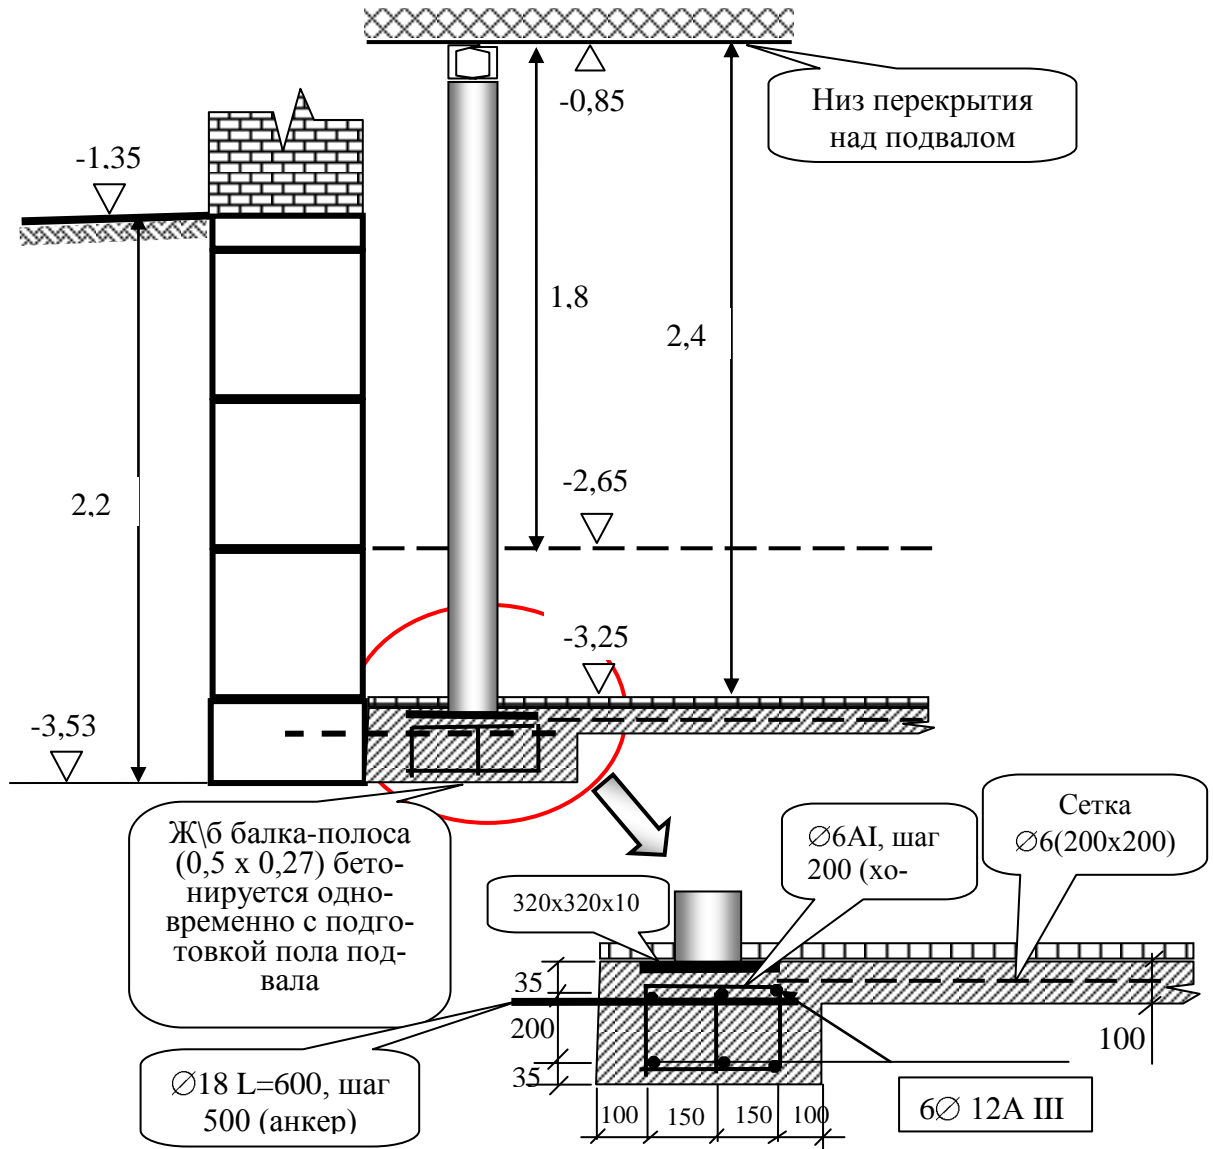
Схема конструктивного усиления основания по расчетным сечениям фундаментов 3-3, 13-13 и др. (бетон ж\б балки-полосы В20)
